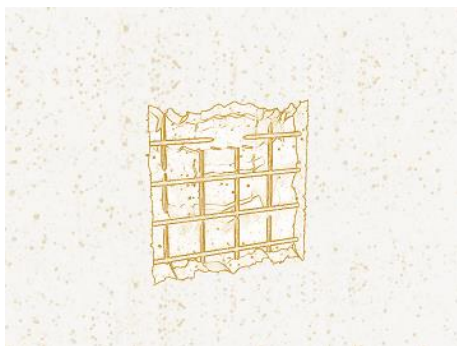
Cala realizada en muro de concreto reforzado. (CYPE Ingenieros, 2019)
